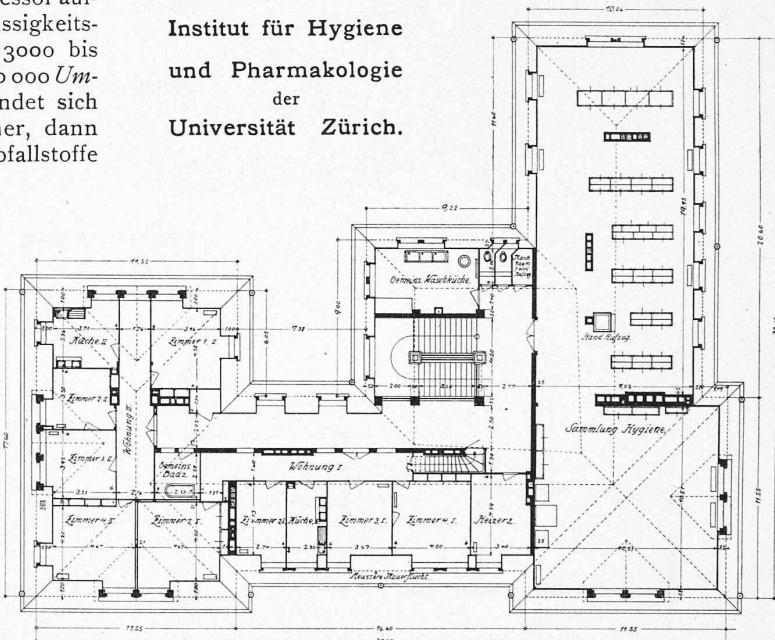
Grundriss vom Dachstock. — Masstab 1:400.
